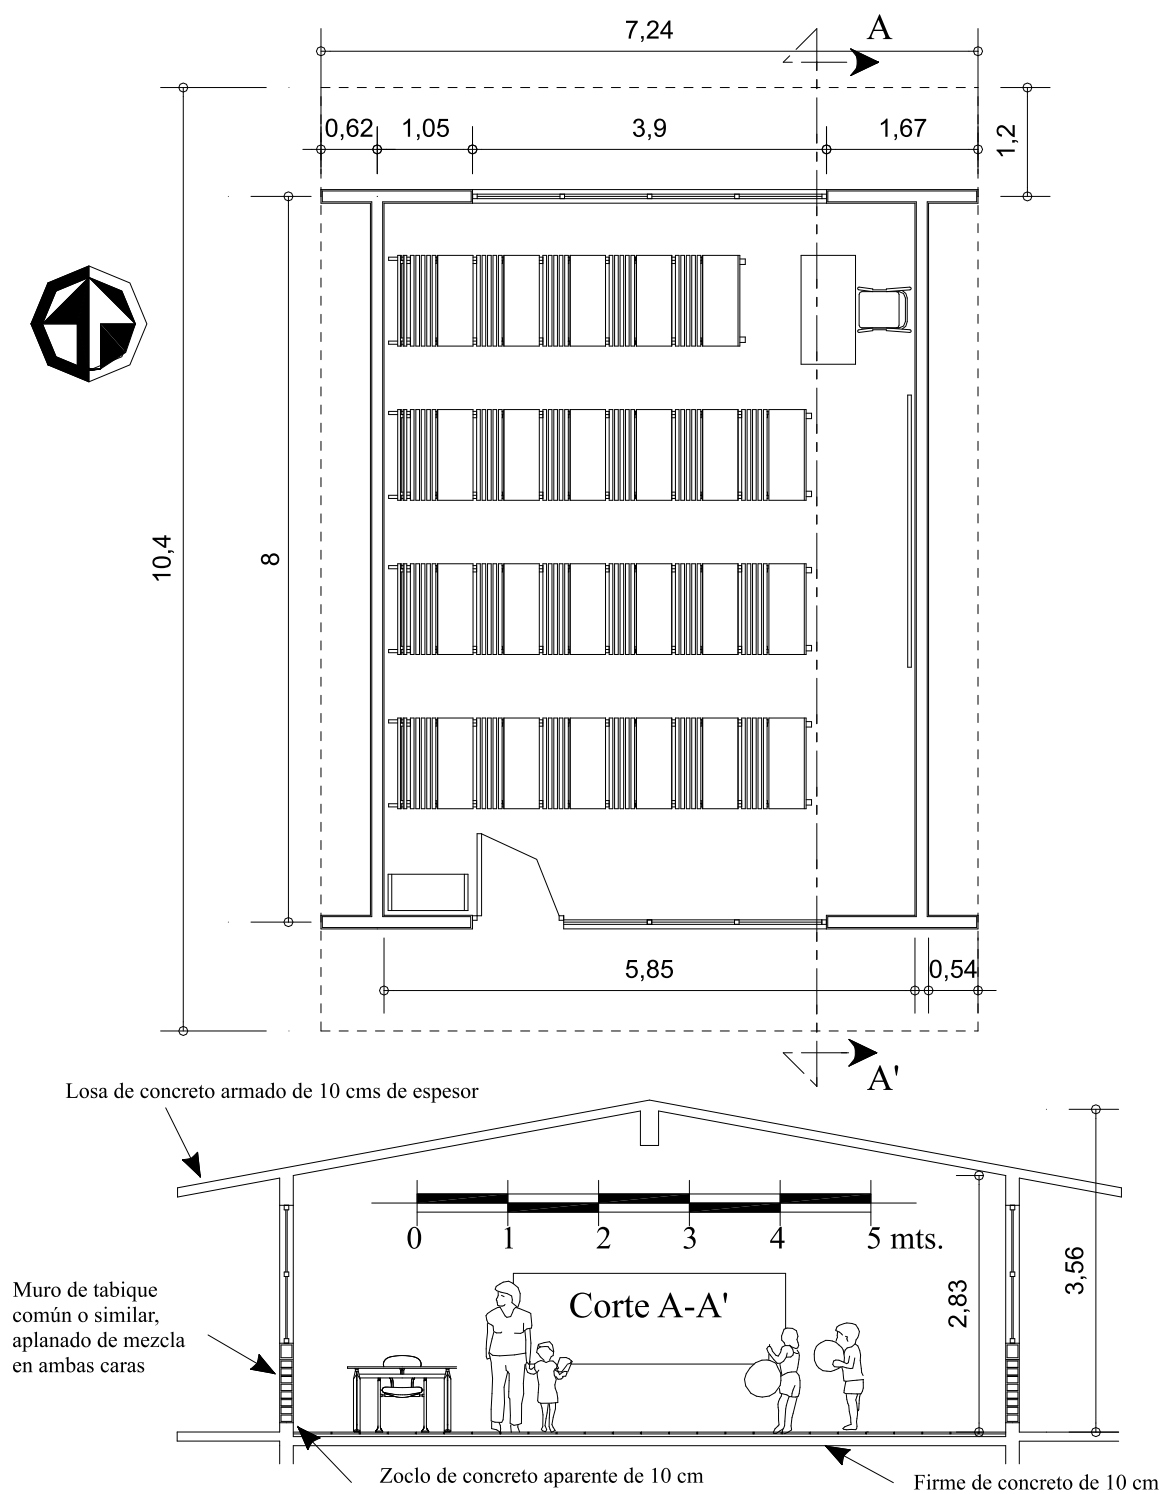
Planta arquitectónica y cortes de un aula del C.A.P.F.C.E.
